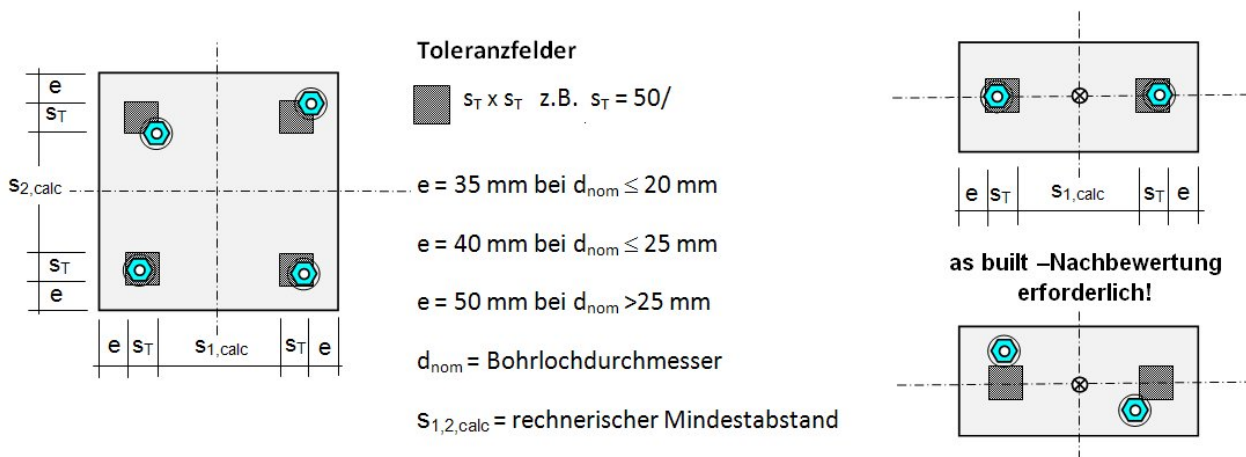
Exemplarische Toleranzfelder bei Platten mit 4 Dübeln und bei Platten mit 2 Dübeln
